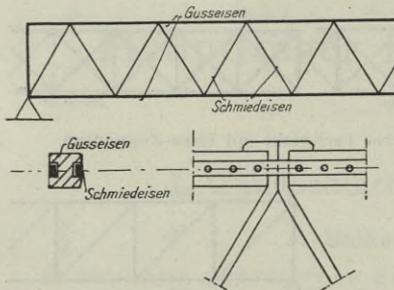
Schied-eisernes Fachwerk ohne Ver-nietung der Knoten.
